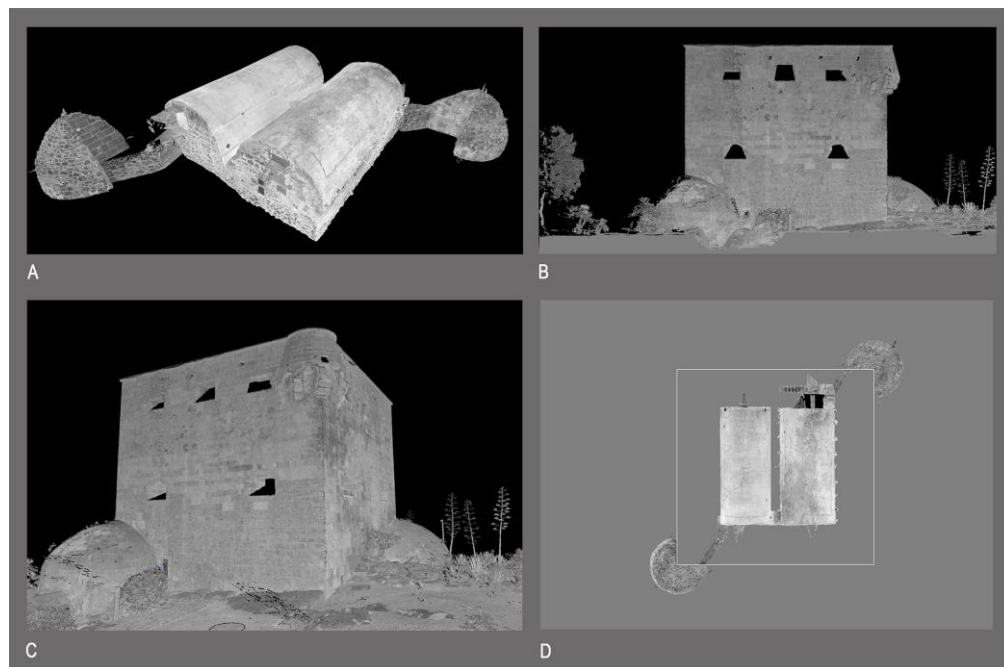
Nubes de puntos obtenida mediante escáner láser 3D.a- Planta baja (interior). B-Alzado Noroeste. C- Perspectiva. D- Planta baja. (Lillo-Verdiani)
